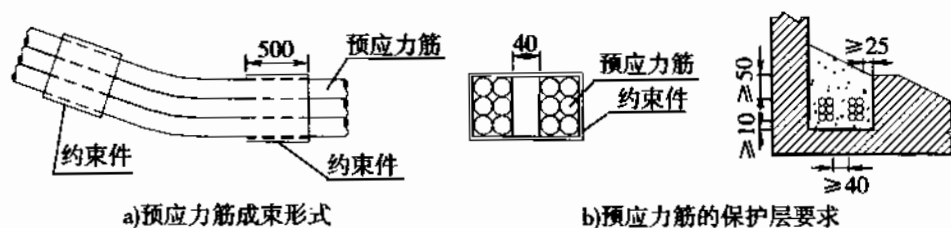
预应力筋成束形式和保护层要求(尺寸单位:mm)
